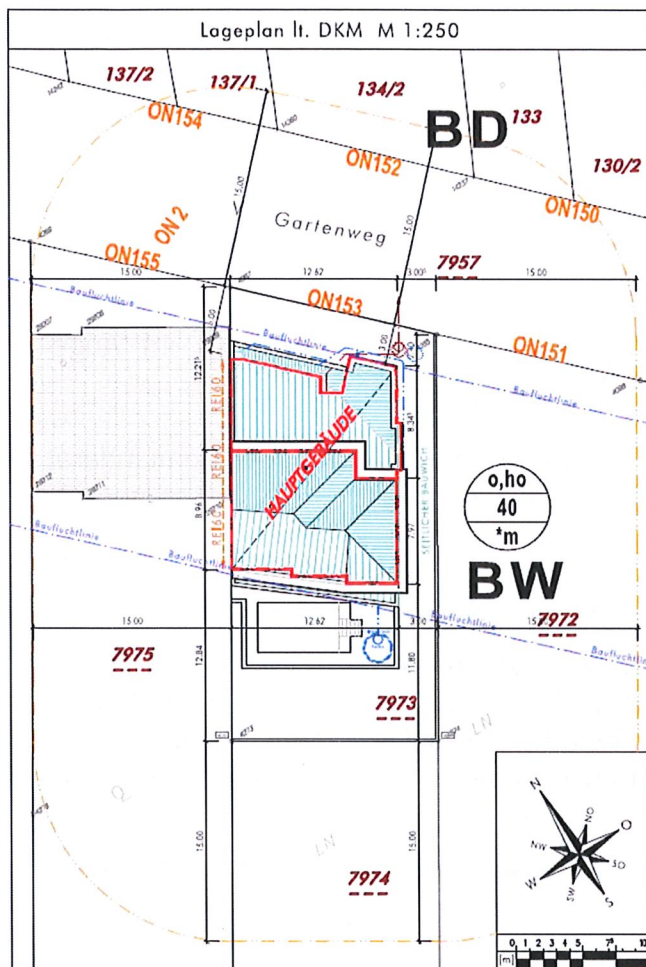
Ausschnitt aus den Planunterlagen Lageplan
